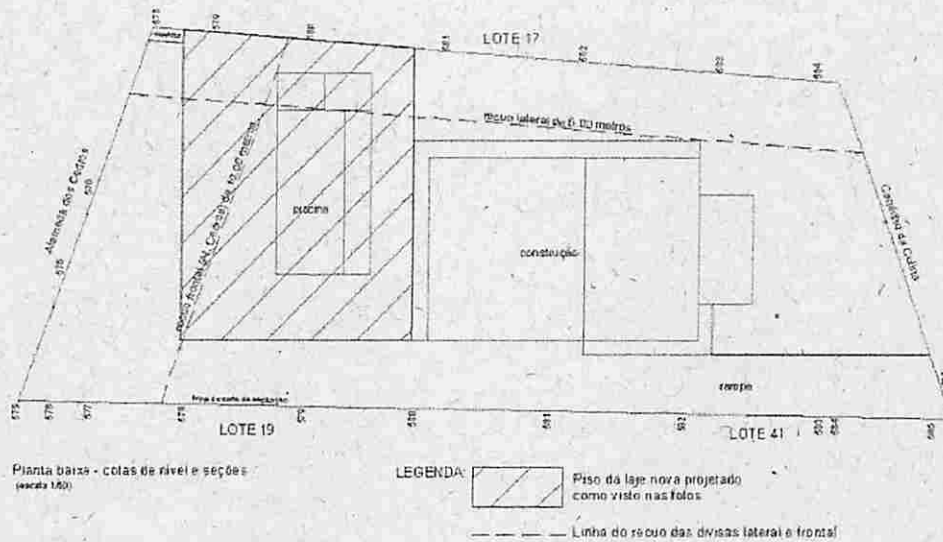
Planta baixa com a ocupação dos recuos frontal e lateral pelo novo piso (em execução).
